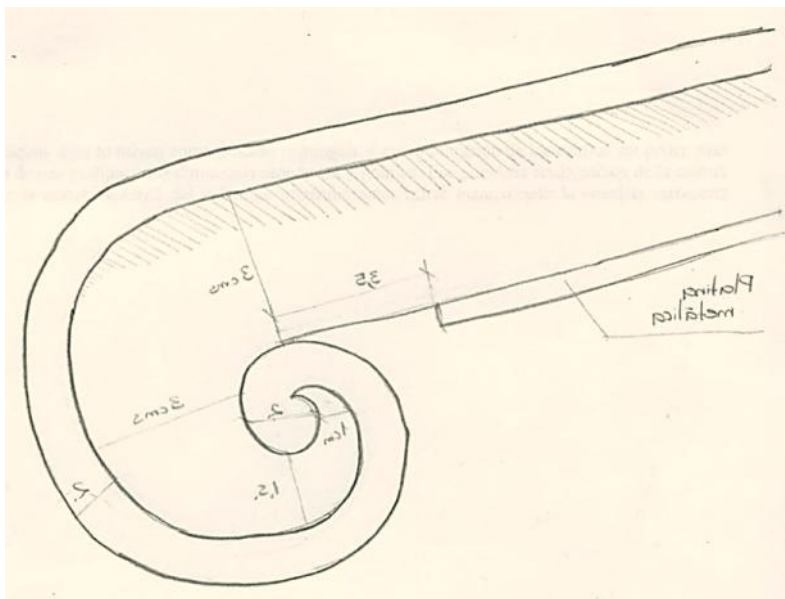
Cartera de campo y alzado del primer tramo de la escalera y barandal
